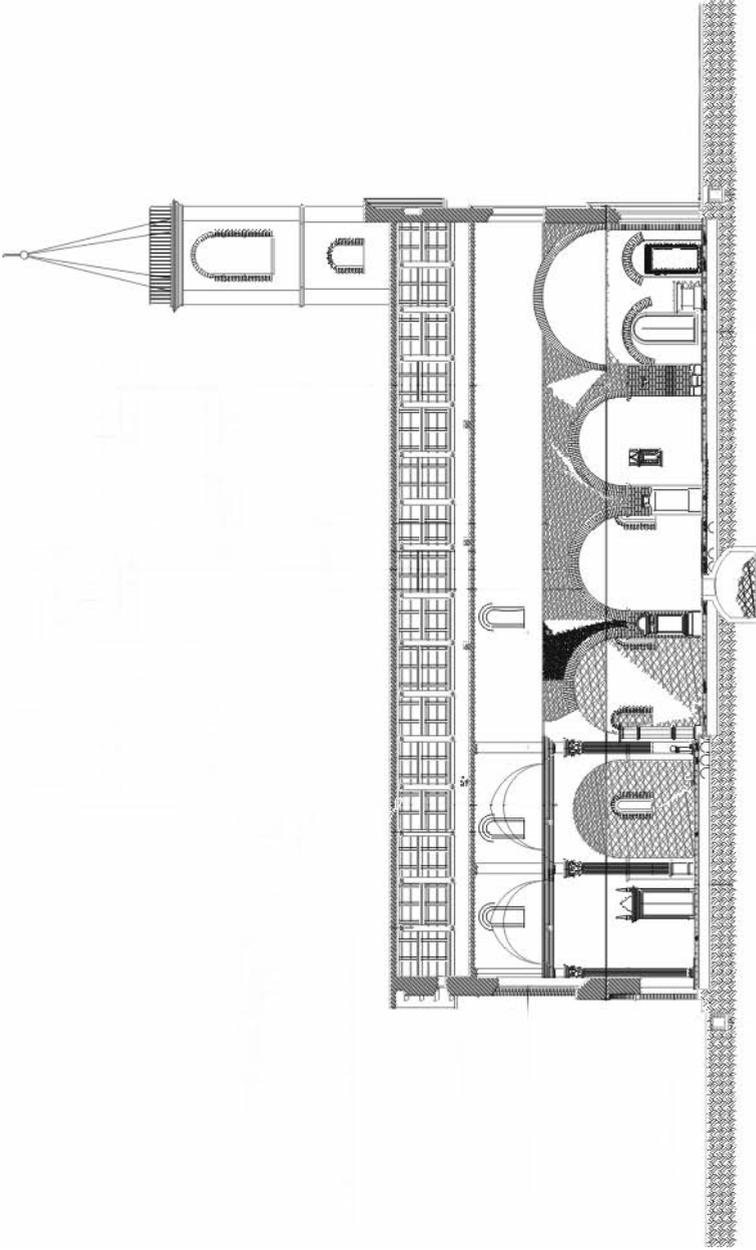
Tiglieto, chiesa di Santa Maria, sezione longitudinale
